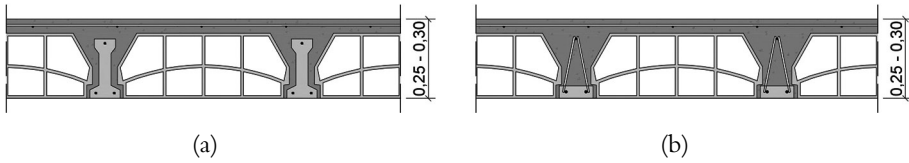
Sección tipo forjado unidireccional sanitario (a) y planta tipo (b).
